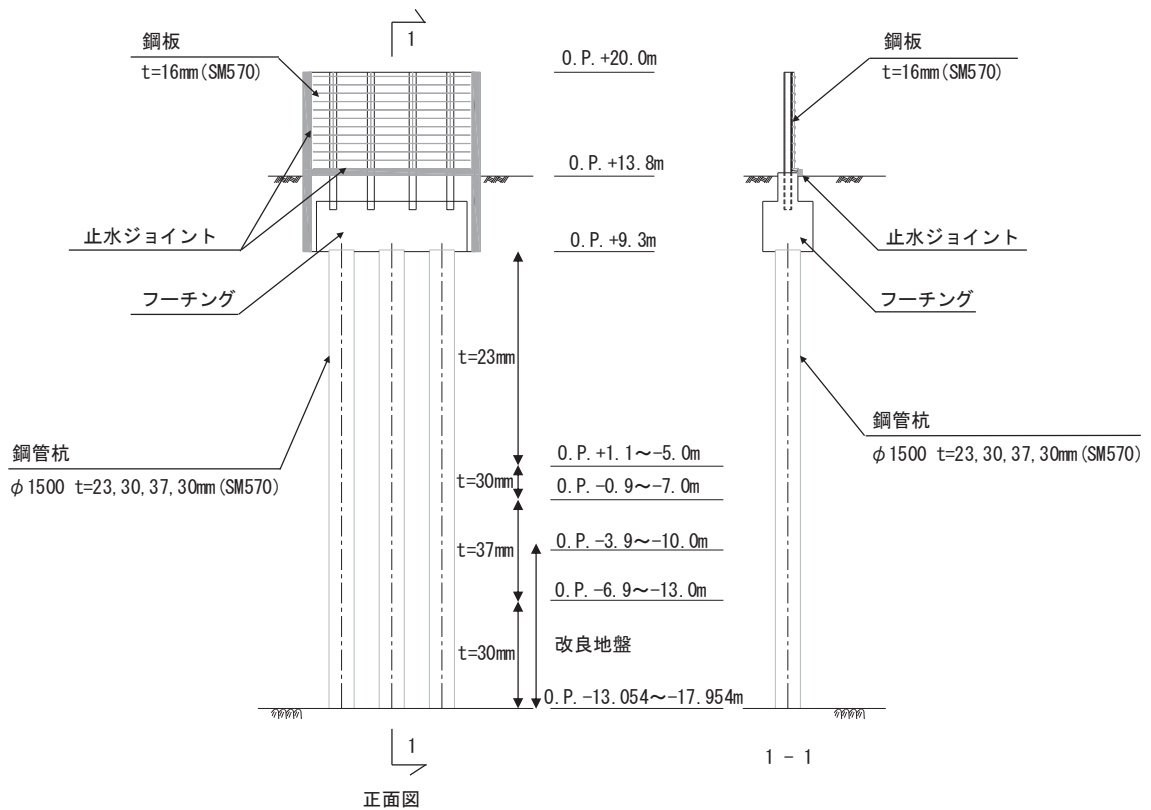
鋼製遮水壁（鋼板）の構造図（正面図及び断面図：I 区間）
